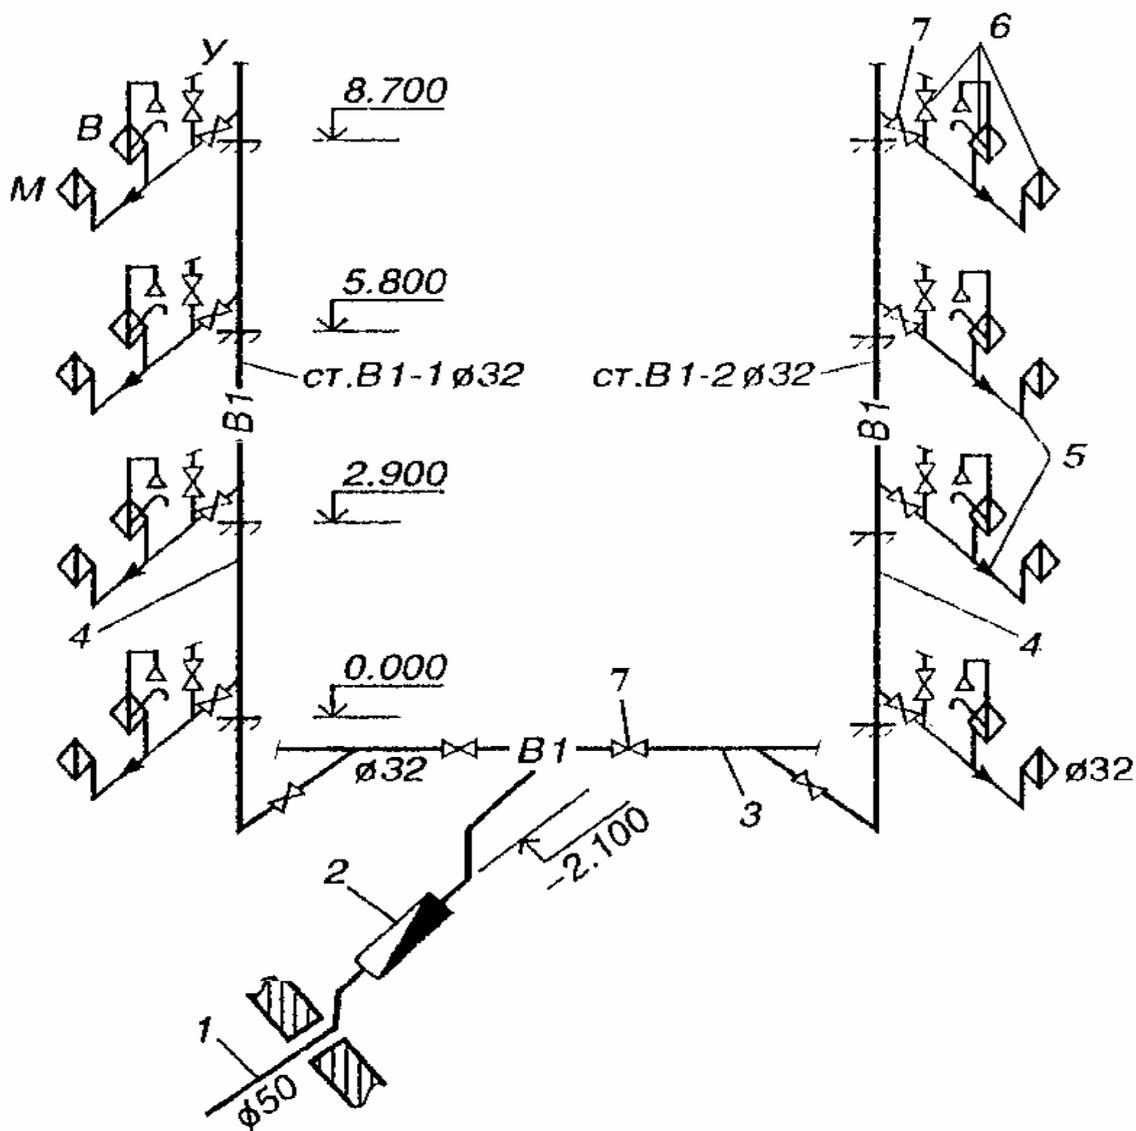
Схема внутреннего водопровода жилого дома.
